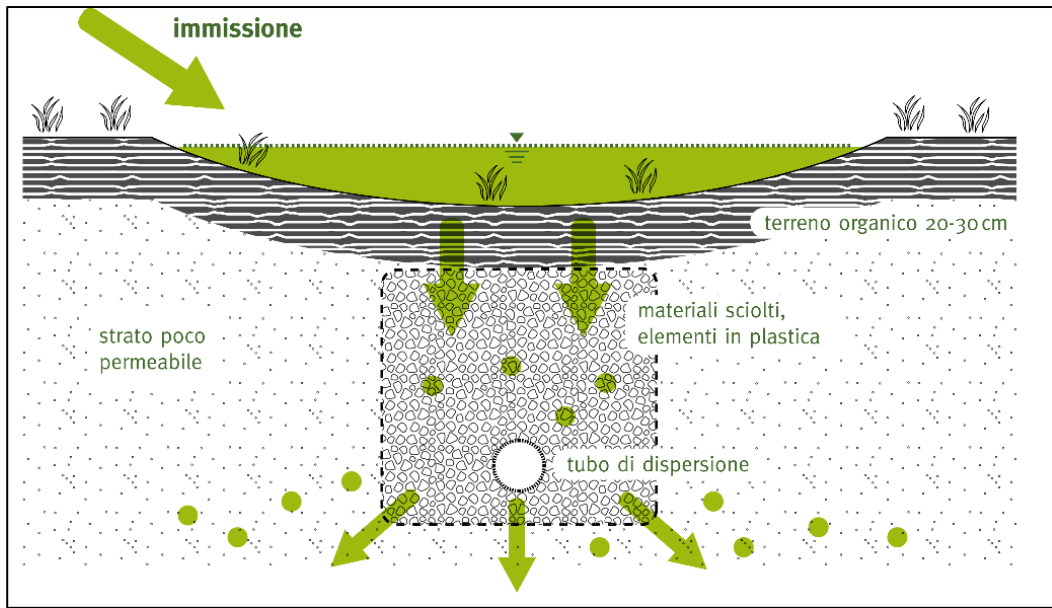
Sezione tipo di un bacino d'infiltrazione.
